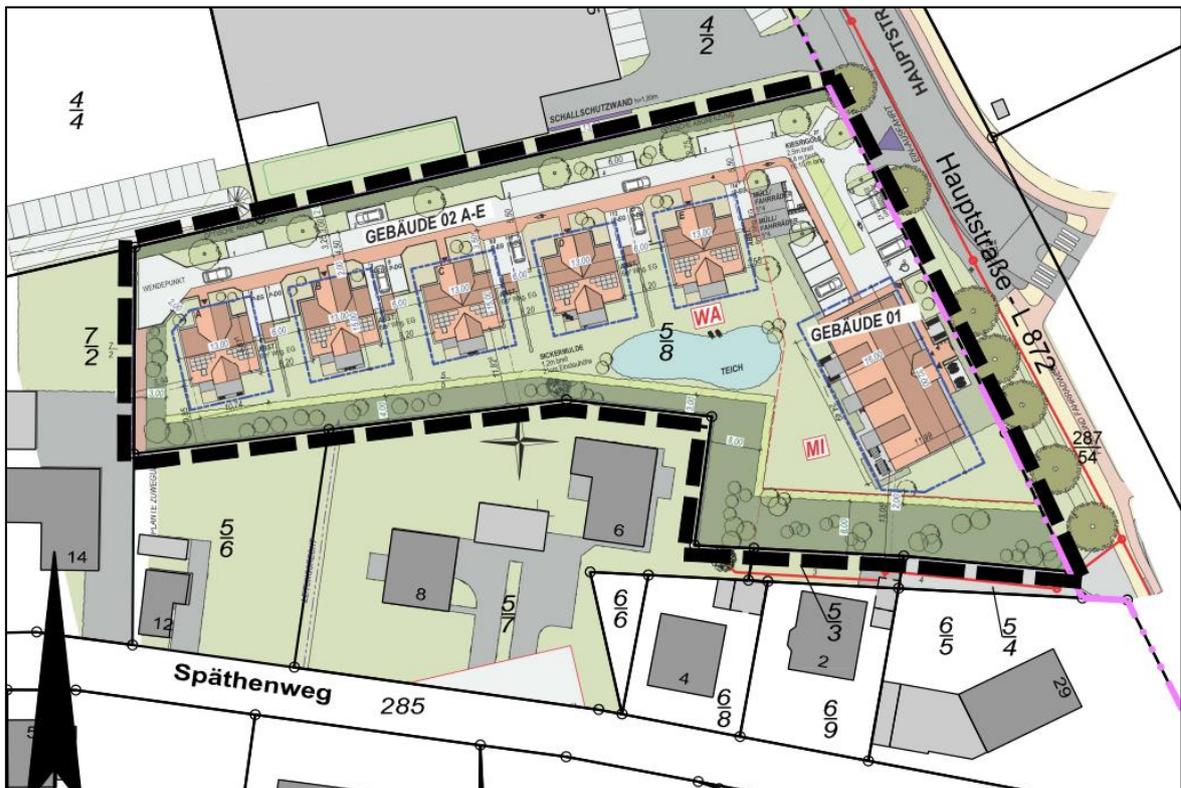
Lageplan der geplanten Wohnbebauung (Quelle [20]).
